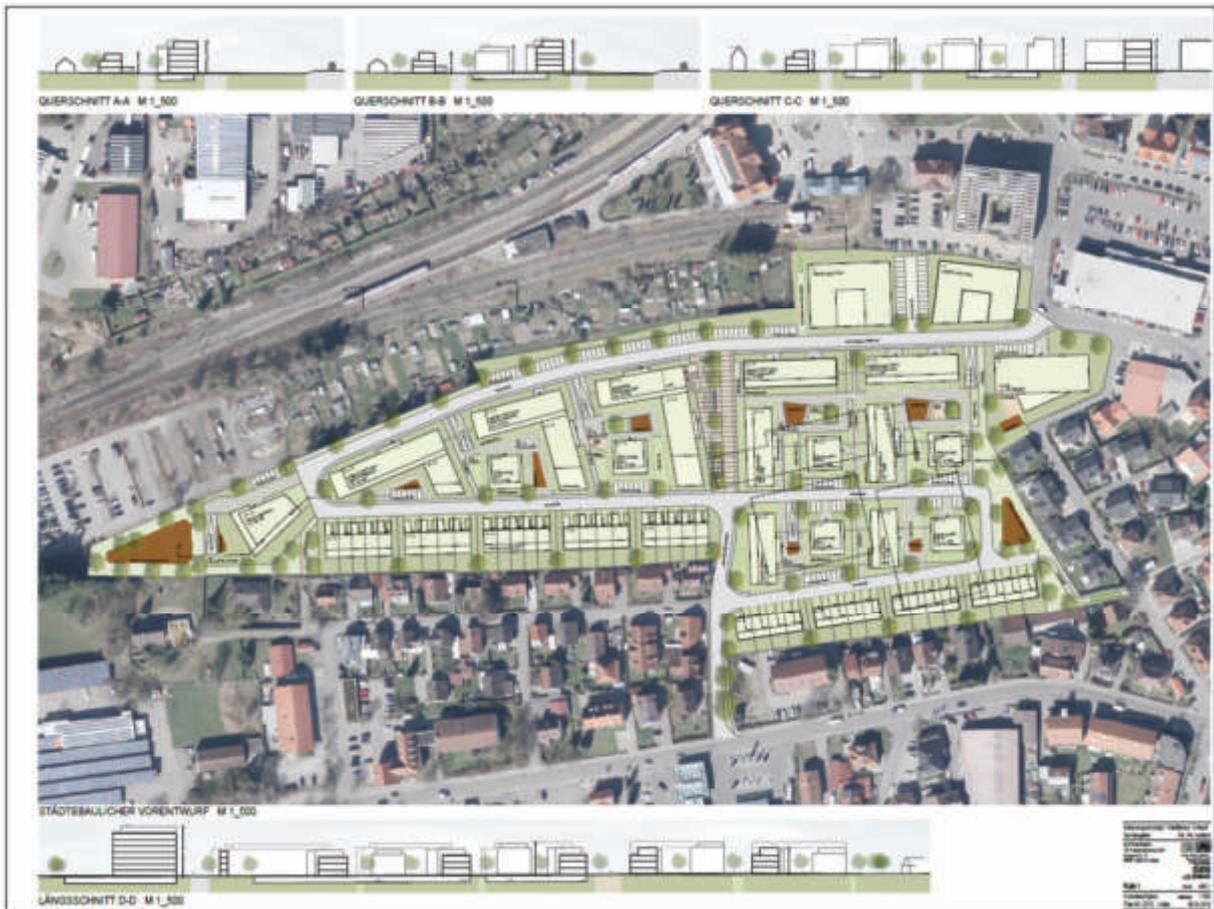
Bebauungsplan Storchengärten (Quelle: Stadt Leutkirch)
